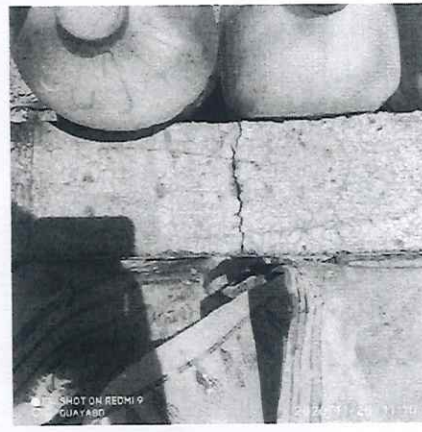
Vista ampliada de fisura en sobrecimiento, no se observa el rayado primario de acuerdo a las especificaciones.
